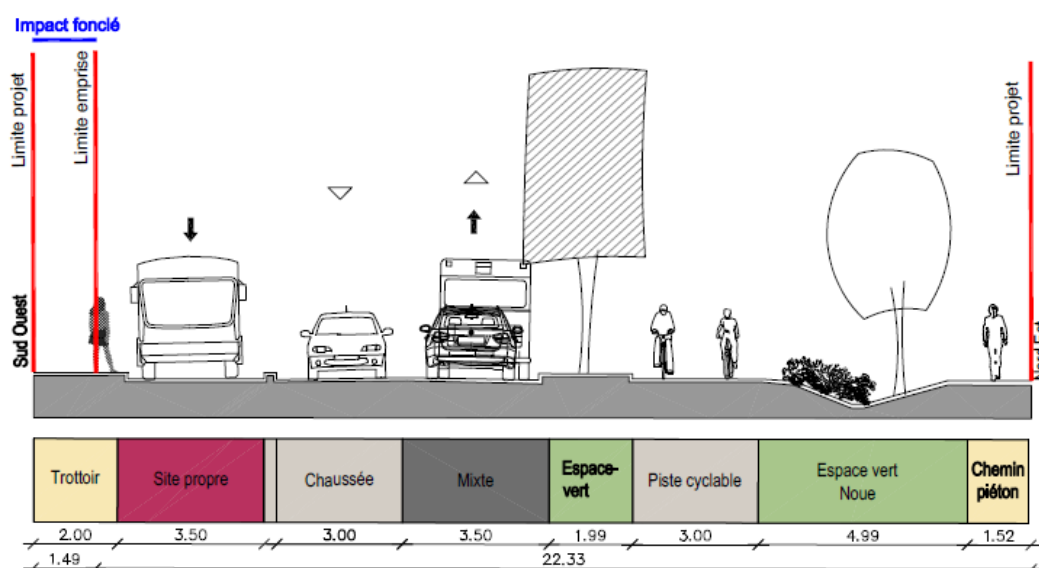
coupe projetée au niveau de l'avenue du Paris
